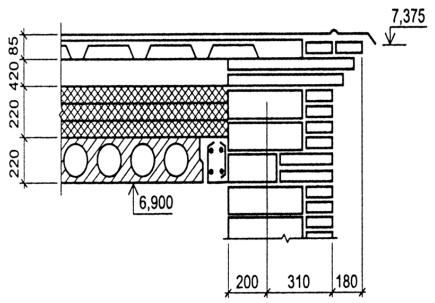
Схема разборки железобетонных плит кровли (сечение 2-2 и 3-3)
